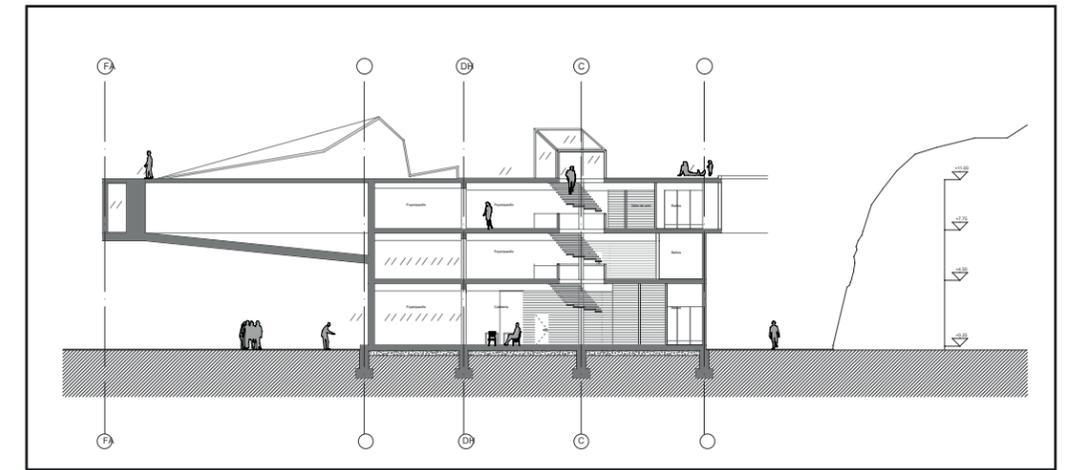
Corte B-B'; Escala 1:50. Por Camilo Sanhueza
